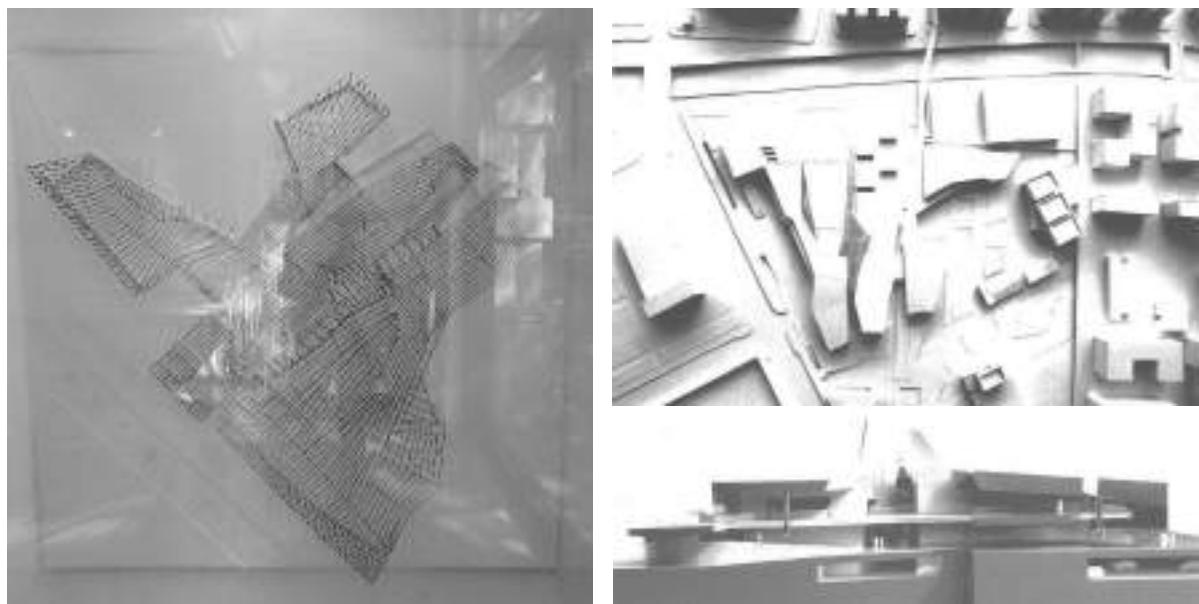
Maquetas materiales: filar, del conjunto y seccionada utilizadas en la definición proyectual.
